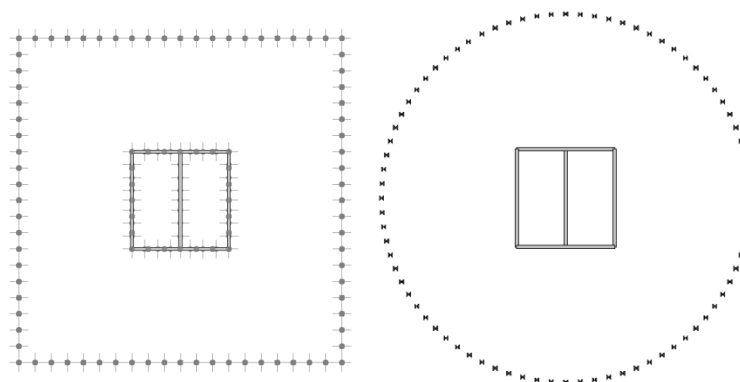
Vista em planta da base dos modelos prismáticos e cilíndricos
